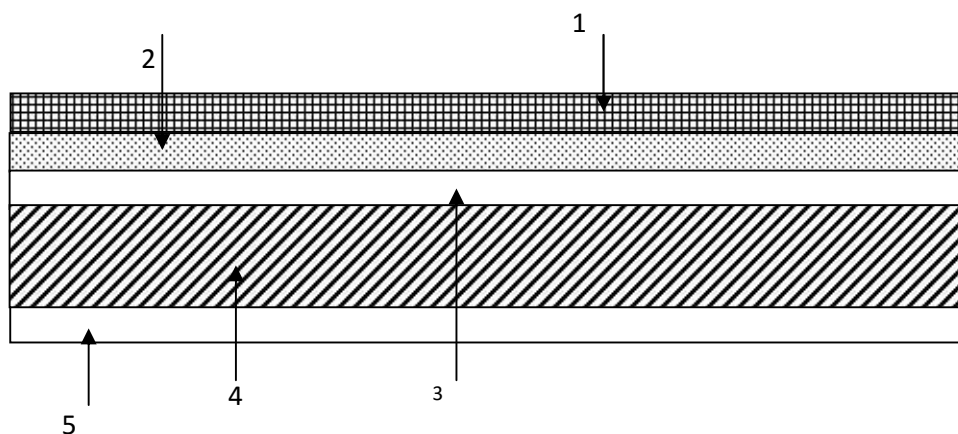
Coupe transversale du plancher terrasse accessible.
